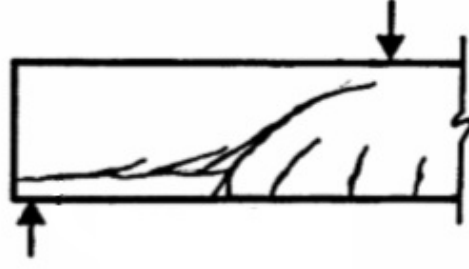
Betonarme kiriş üzerinde geleneksel kiriş ve kemer davranışı [5]
